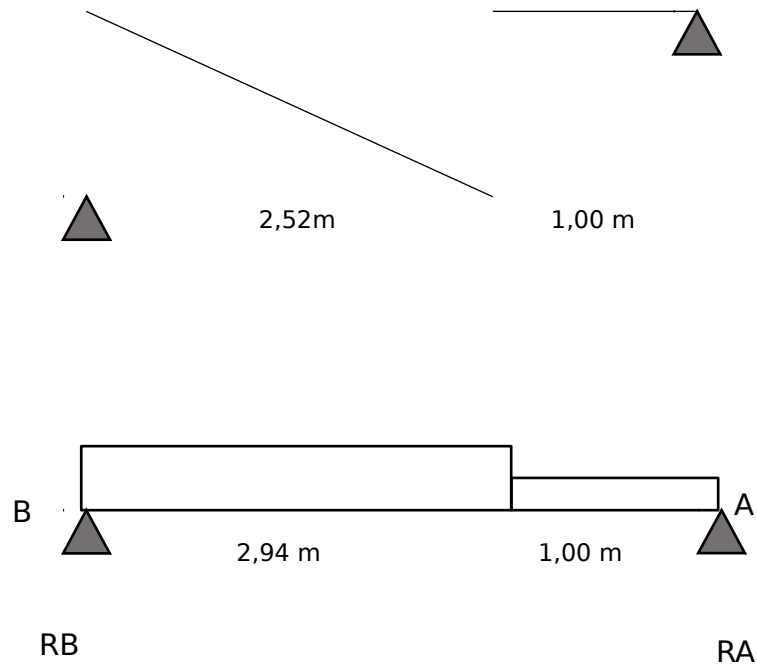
vue en plan plus schéma statique du type d'escalier.
